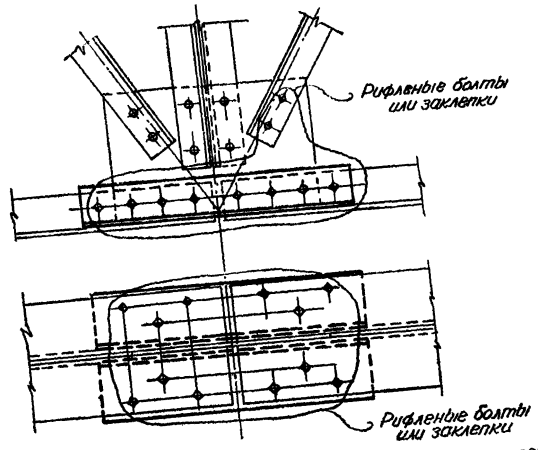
Примеры решения стыков поясов клепаных ферм: а) стык верхнего пояса; б) стык нижнего пояса
